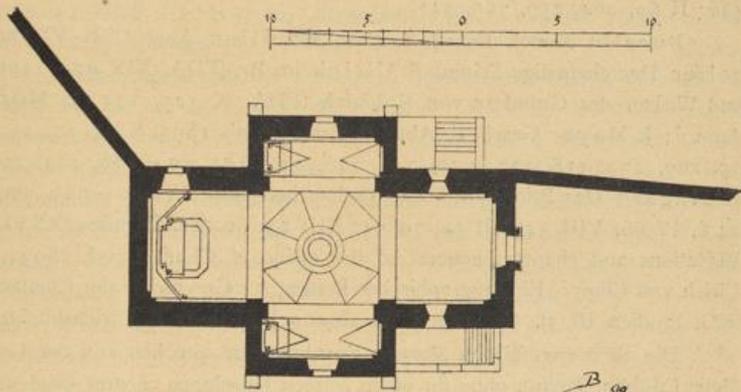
S. Trudpert. S. Trudpertskapelle. Grundriss.
